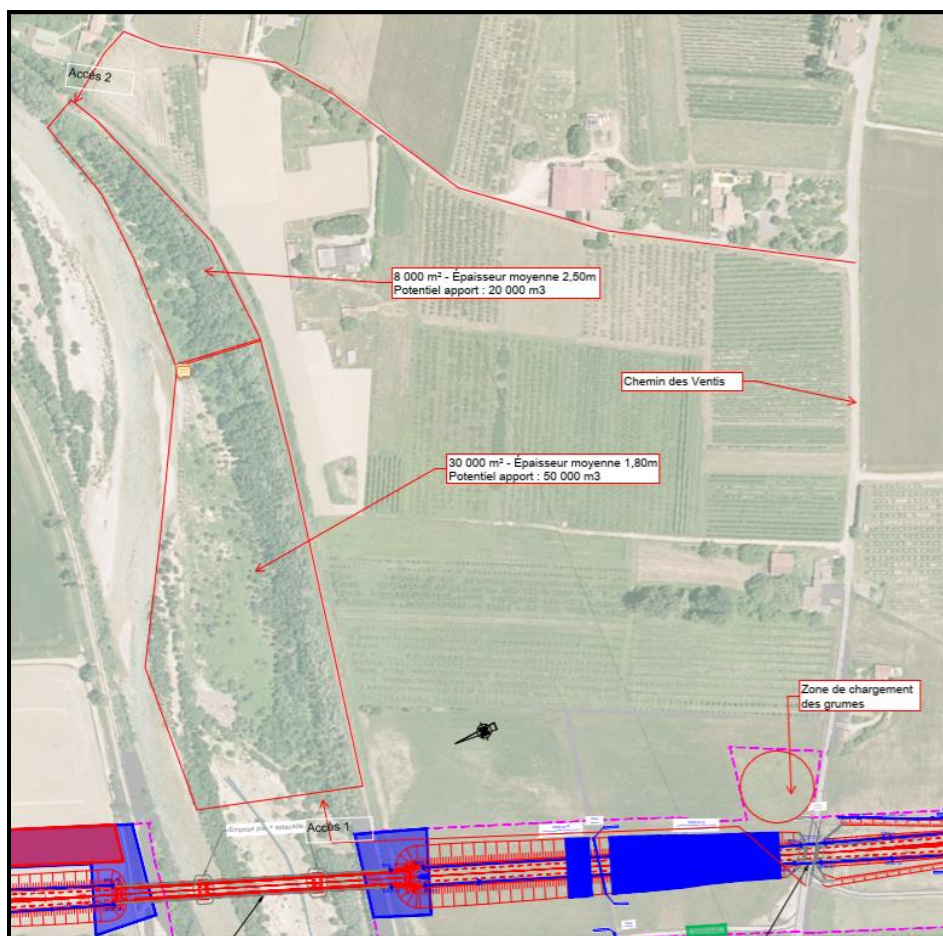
Plan de situation du secteur d'étude (source : Ingérop)
